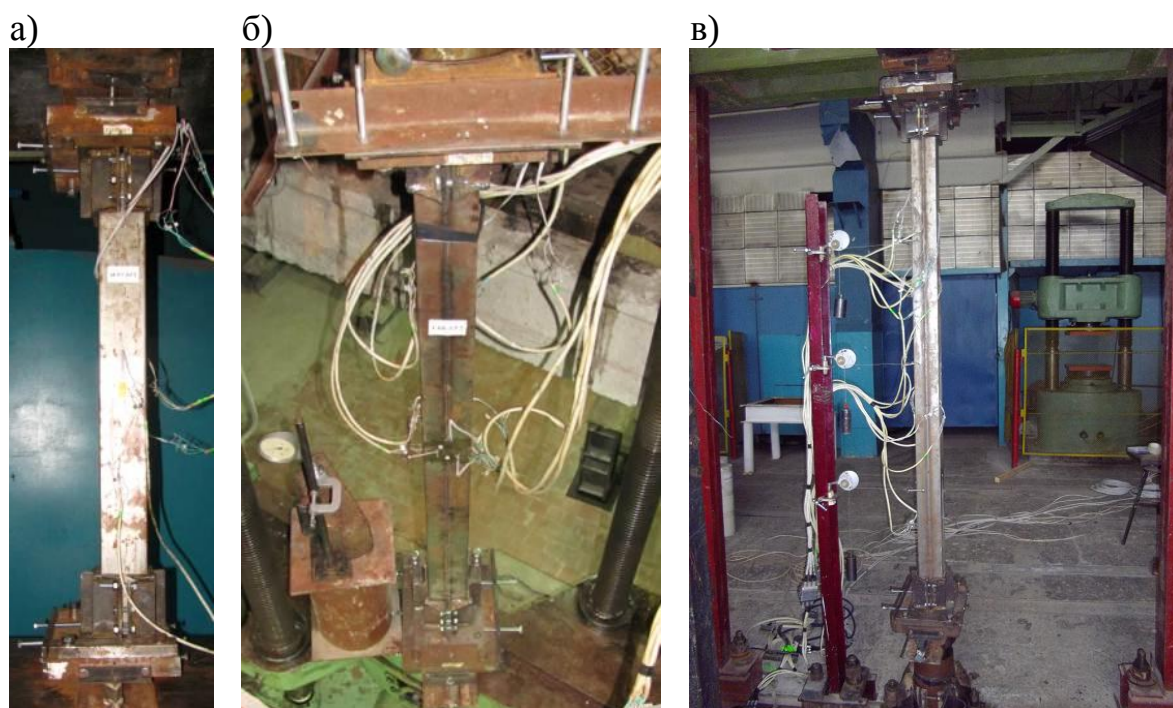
Зовнішній вигляд сталобетонних колон квадратного поперечного перерізу до проведення випробувань: а - колони серії СБК-1.0-1, б - колони серії СБК-1.5-1, в - колони серії СБК-2.0-1.
